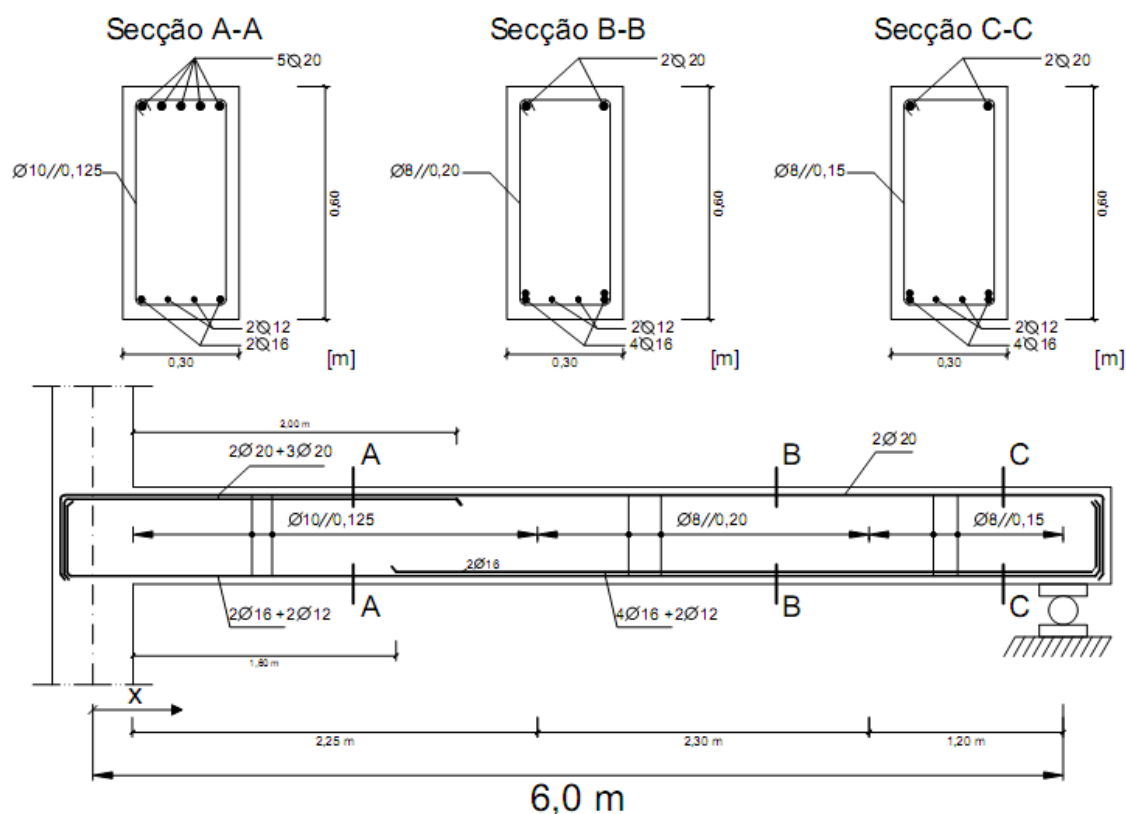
Pormenorização da armaduras (Caso B – secção retangular)
